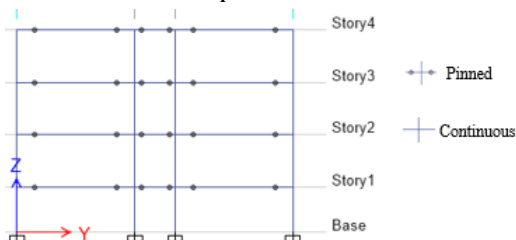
Denah Konfigurasi Portal 1 dan portal 6
